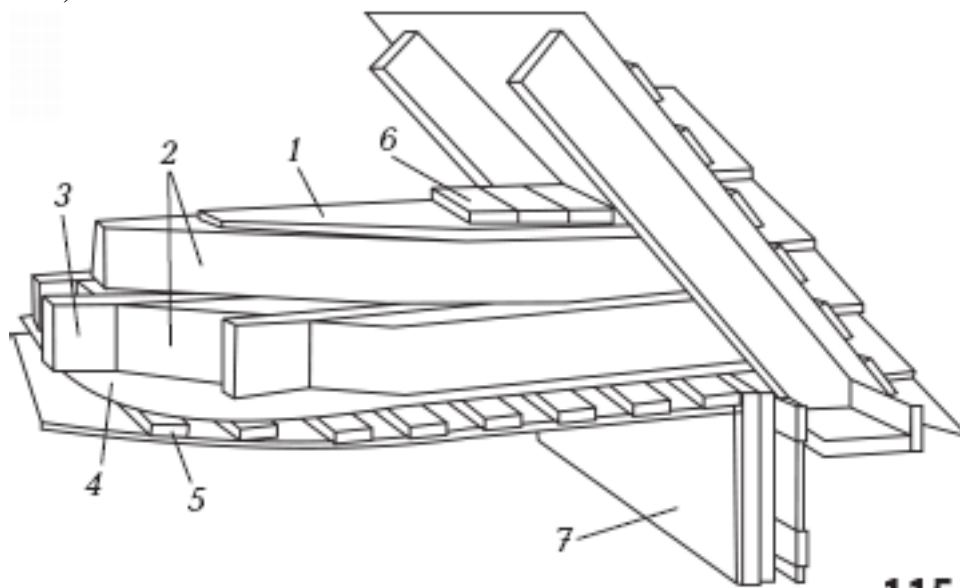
Схема утепления перекрытий по деревянным балкам: 1 – гидроизоляция; 2 – утеплитель; 3 – балки перекрытия; 4 – пароизоляция; 5 – обрешетка; 6 – ходовой настил; 7 – внутренняя отделка
